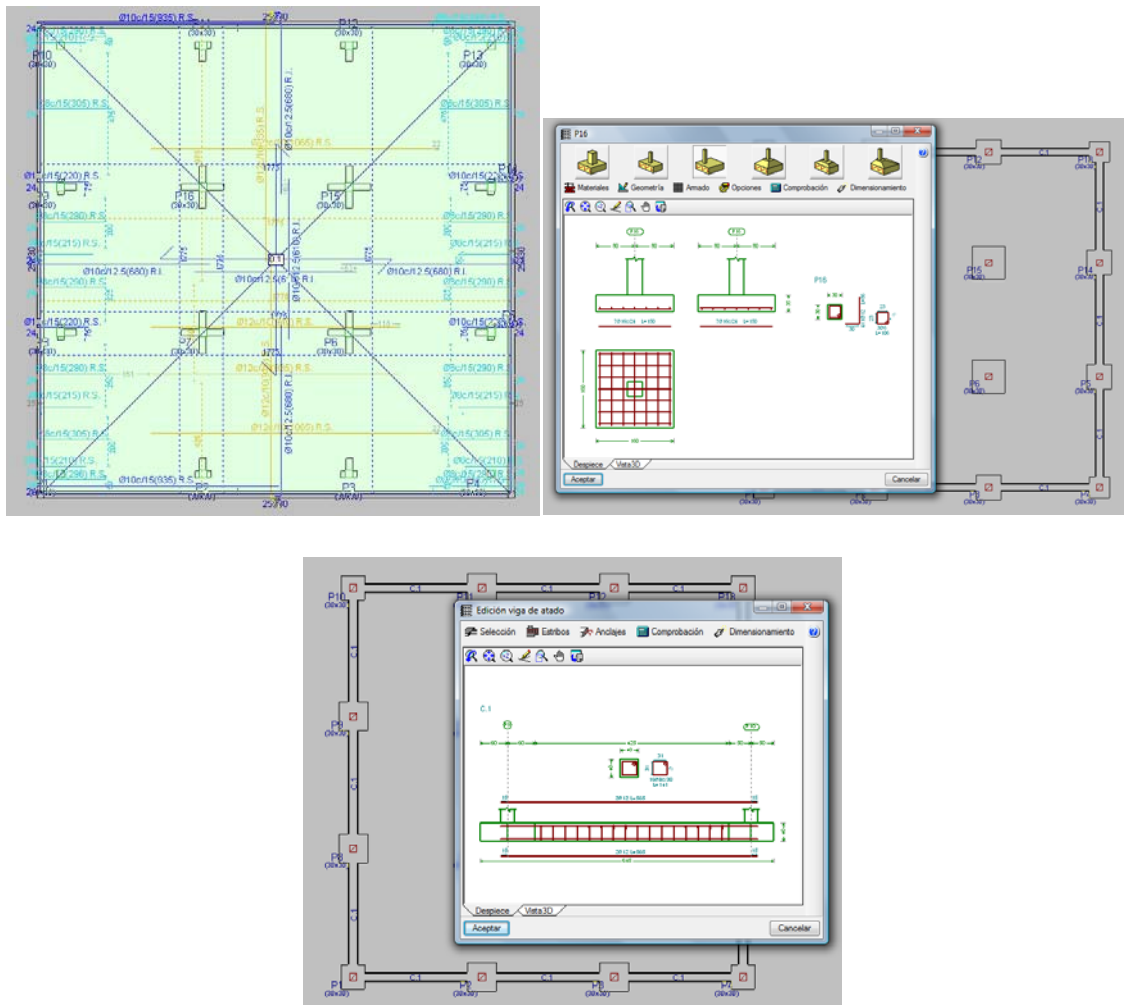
Resultados de losa, zapatas y vigas de atado (Edificio)
